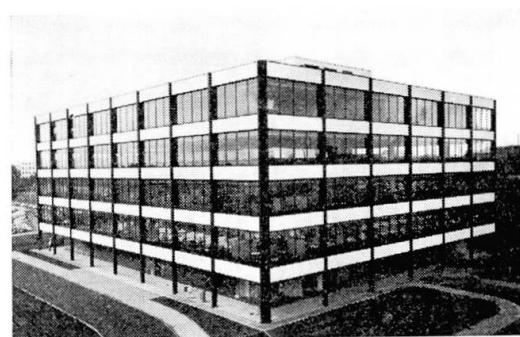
Krupp-Verwaltungsgebäude, Rheinhausen. Unverkleidete Stahlkonstruktion.
